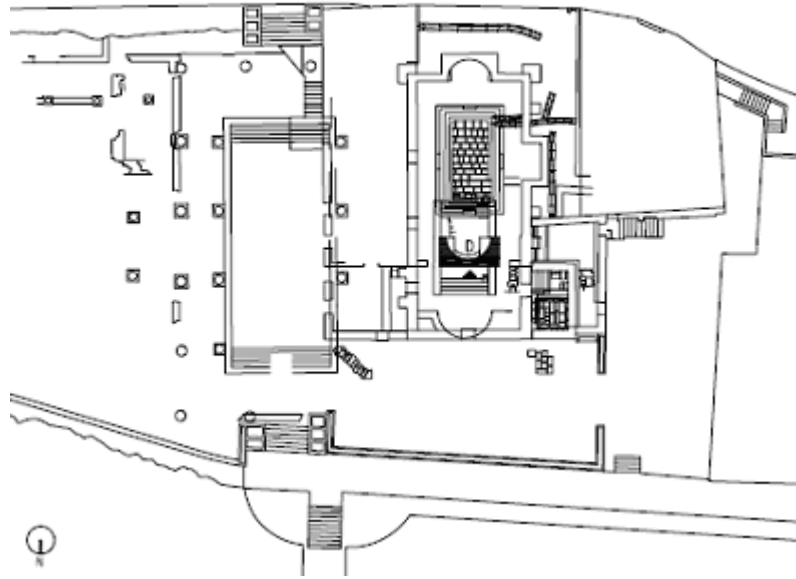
Planta e parede D , a norte (Frade, 2000).
